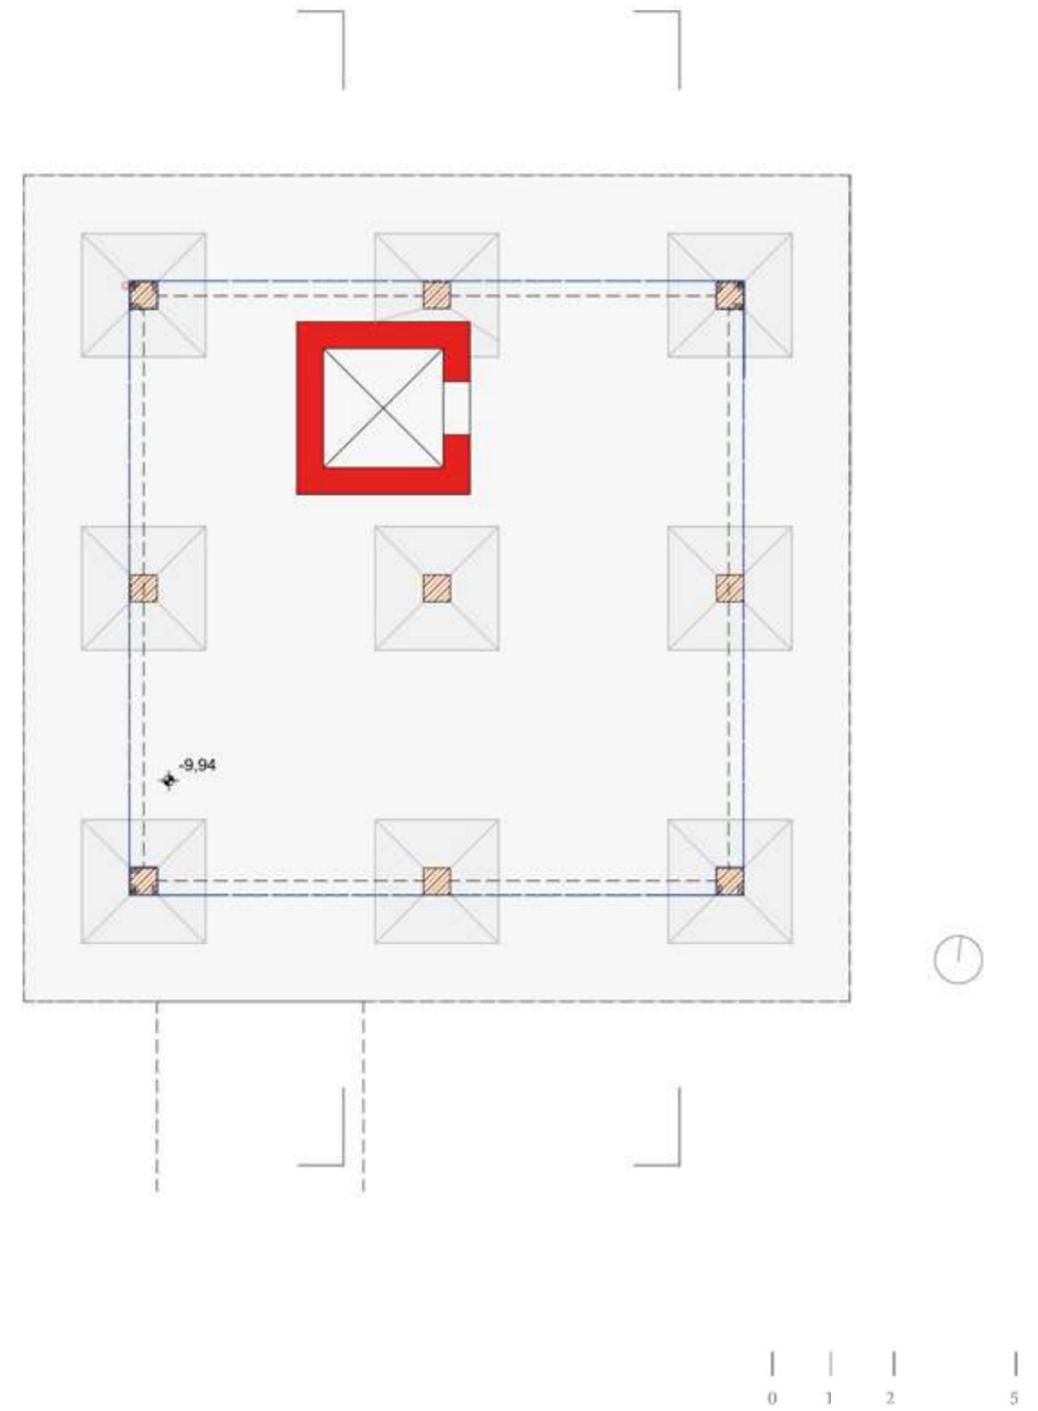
Grundriss Untergeschoss Jagdkanzel, M 1:100
